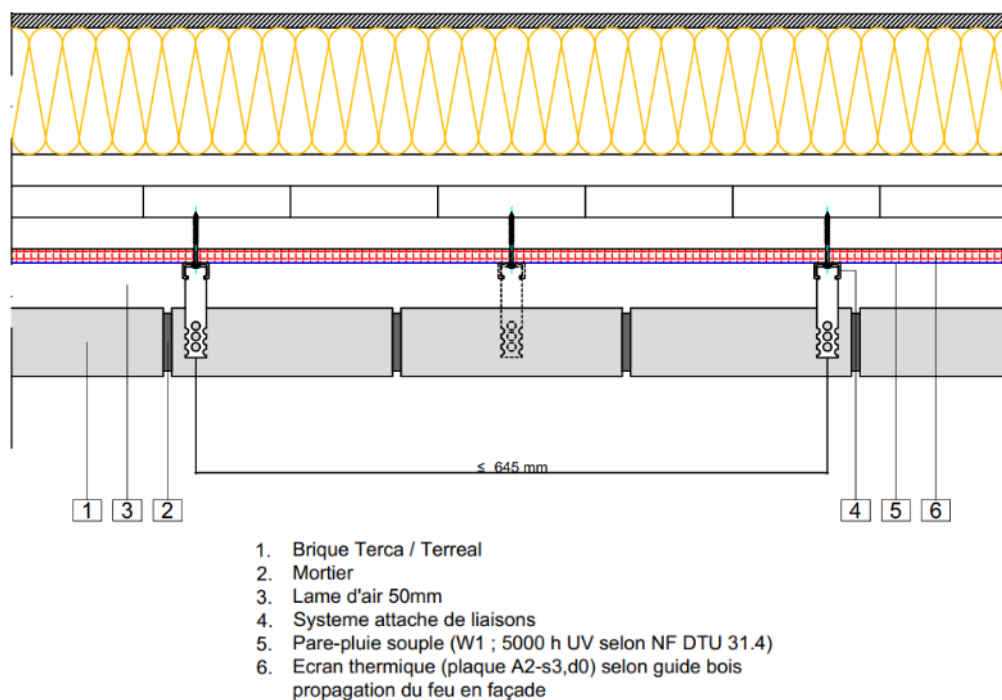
Panneaux structuraux massifs bois – Coupe horizontale – sans ITE – écran thermique plaque
